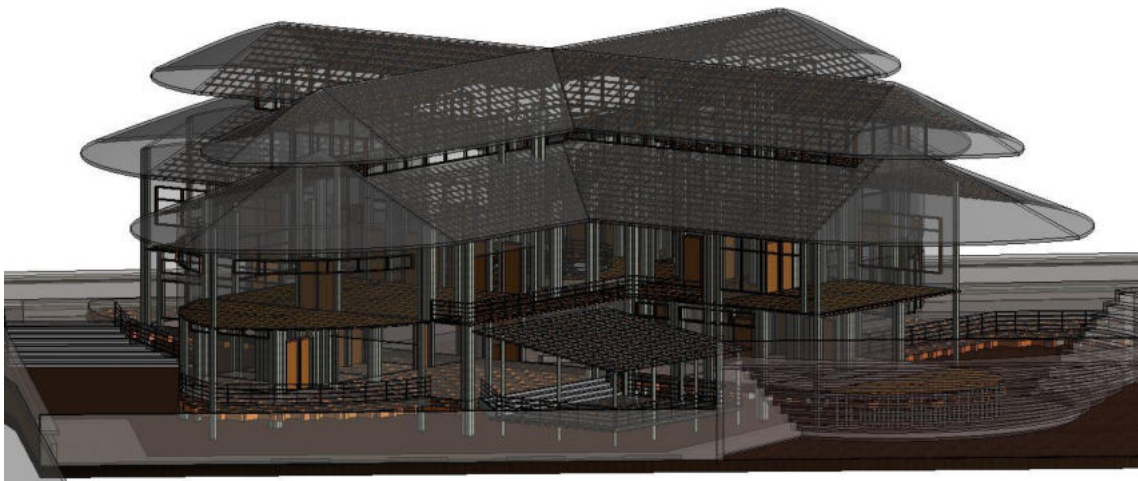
Modelo Estructural del Proyecto (Elaboración propia)
